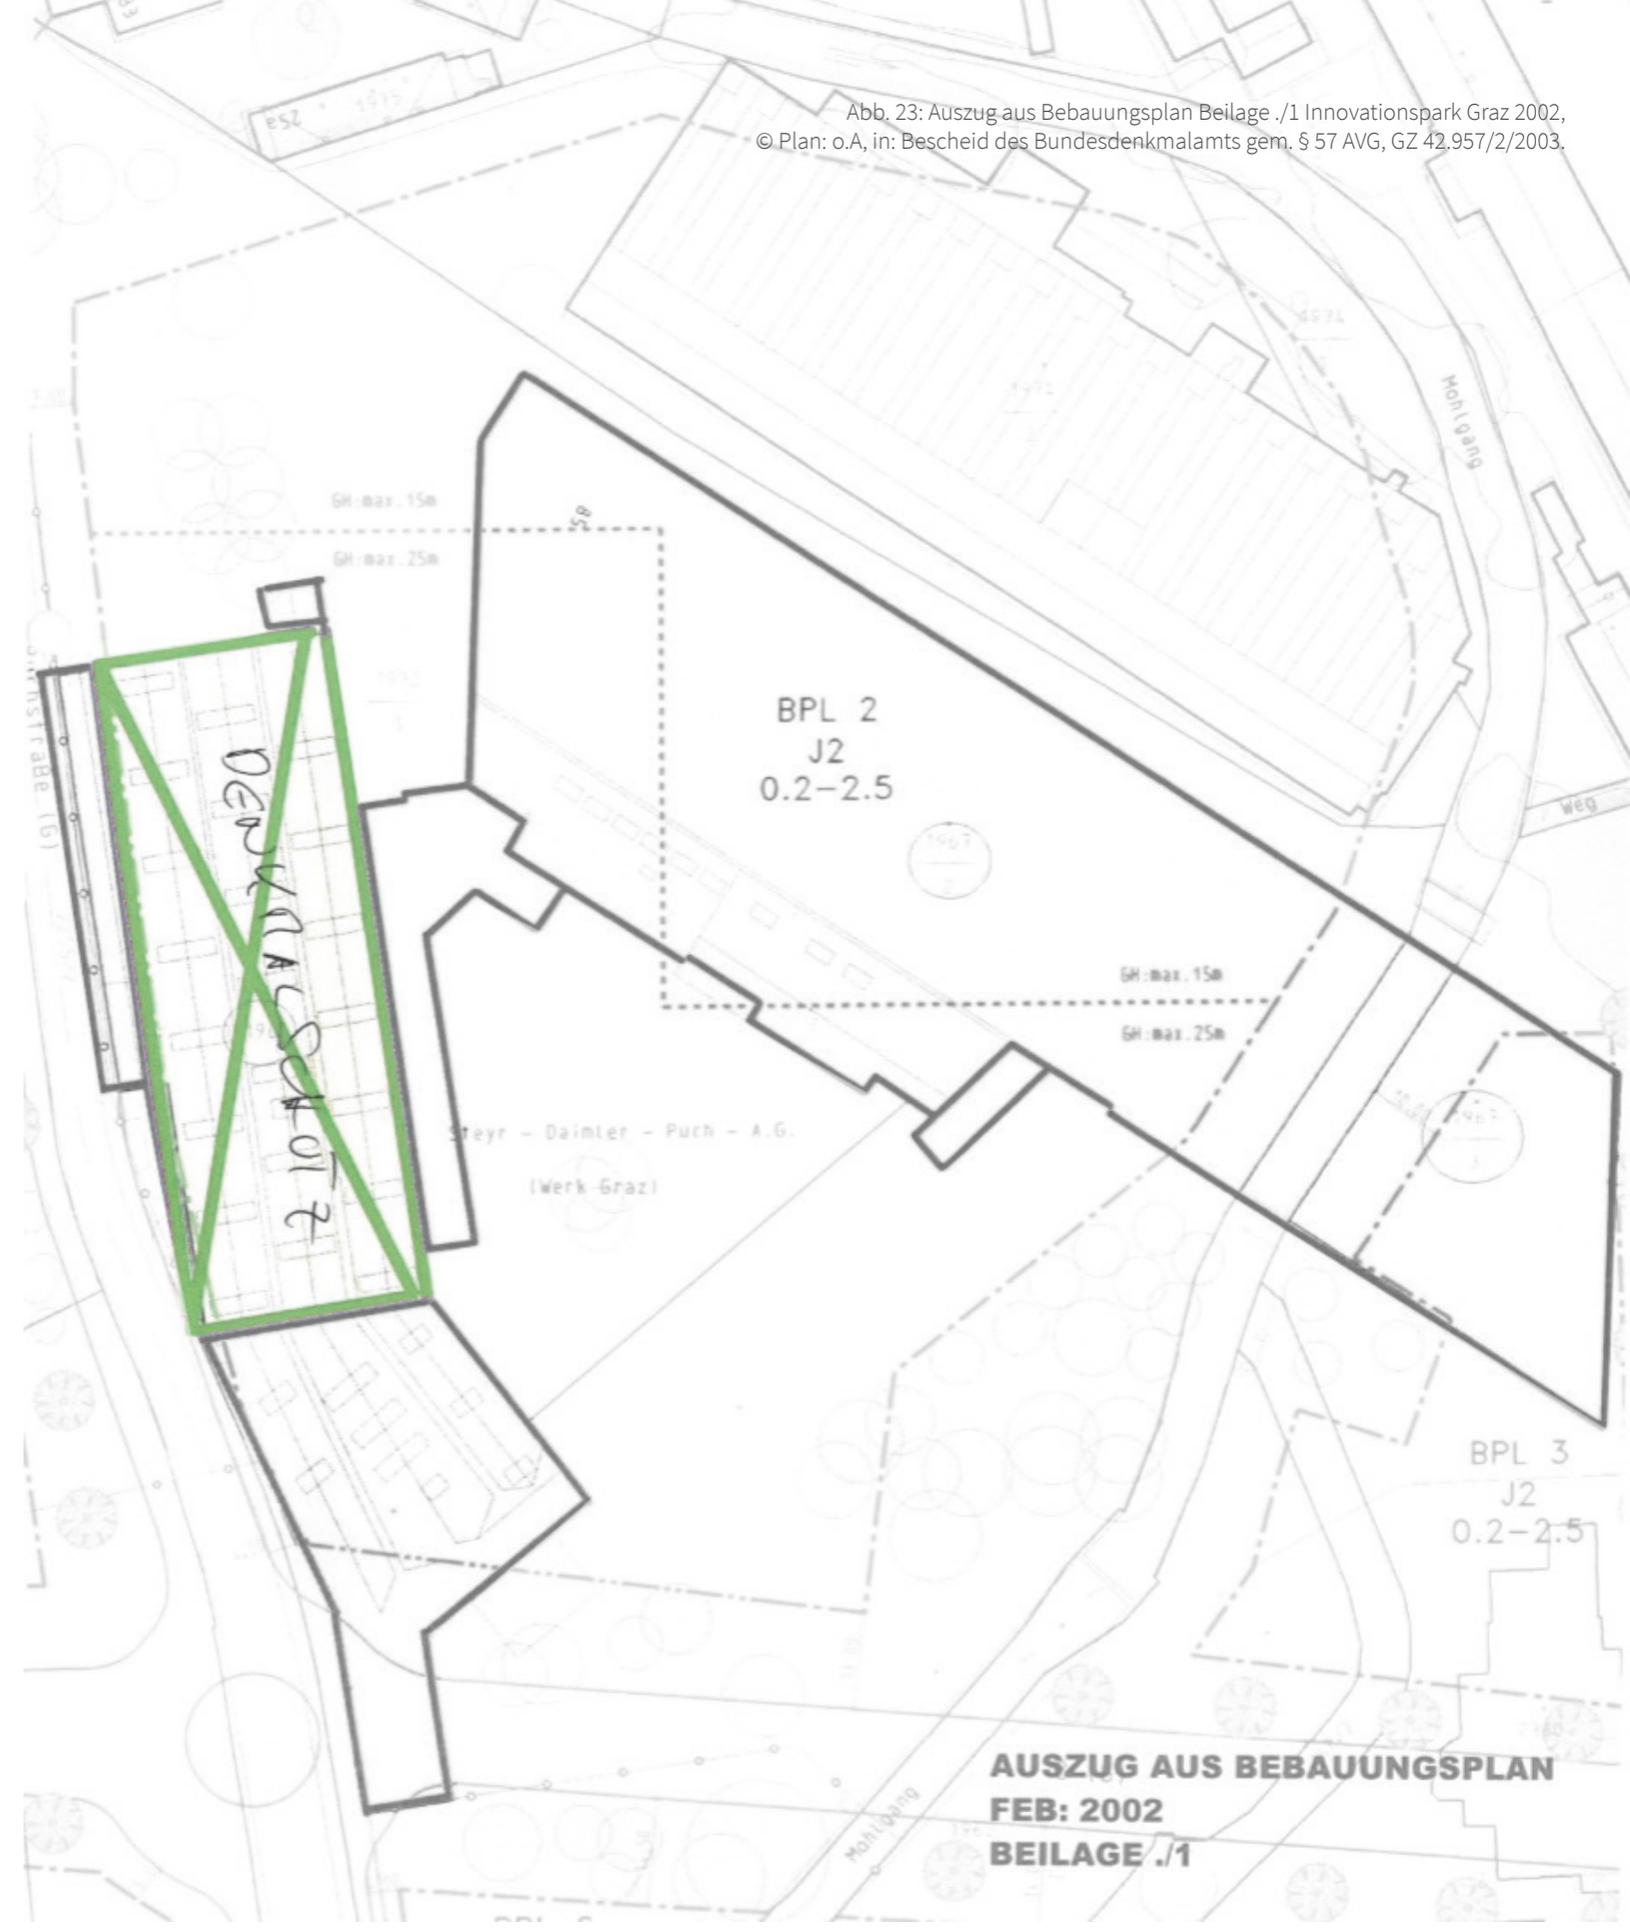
Auszug aus Bebauungsplan Beilage ./1 Innovationspark Graz 2002,
